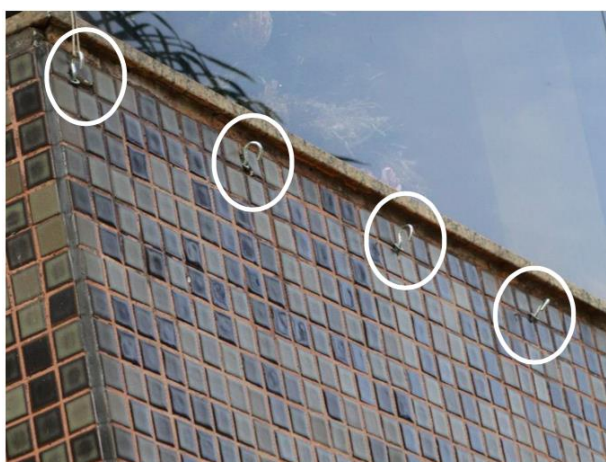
Corte das cerâmicas para instalação dos ganchos de fixação da tela de proteção
